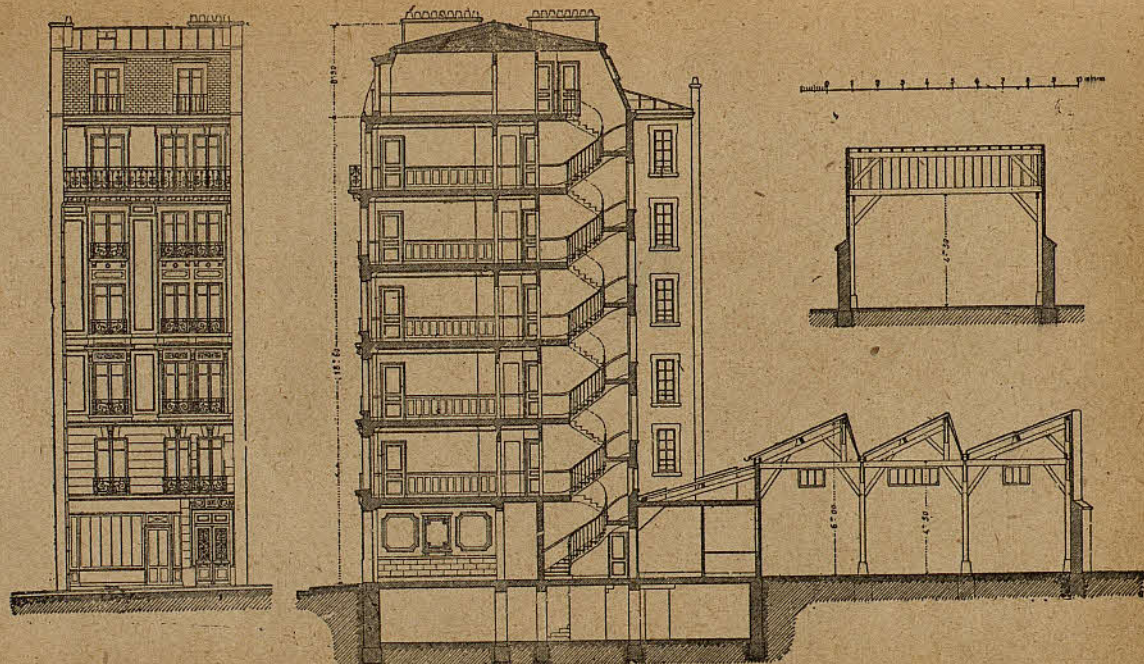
á 282.—Armadura para taller con iluminación por la vertiente que da cara al Norte (sistema Shed).
